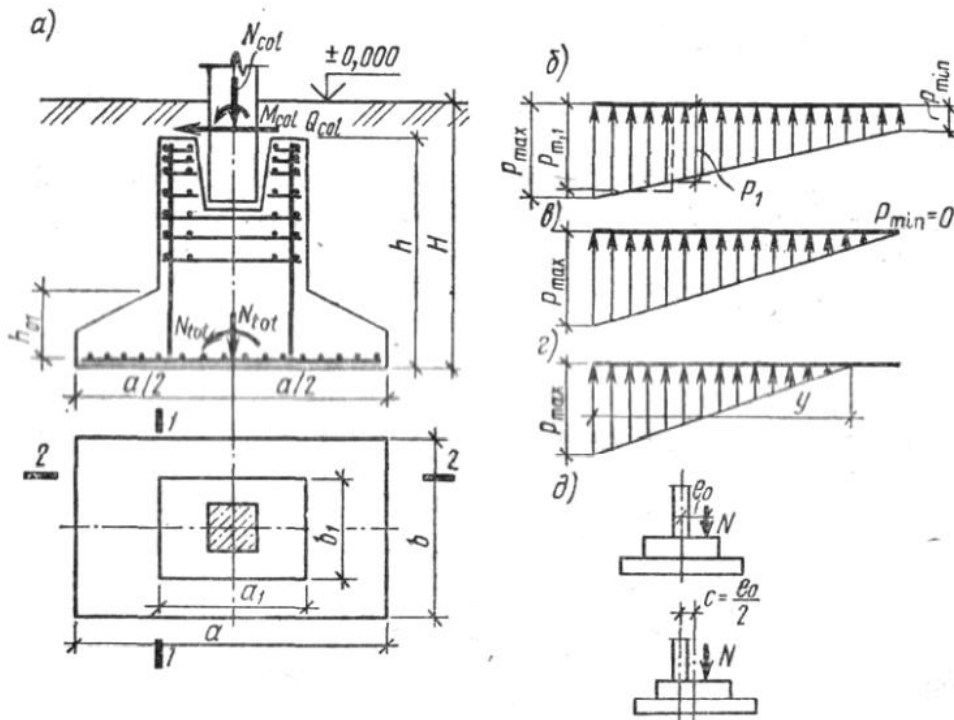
К расчету отдельных внецентренно нагруженных фундаментов:
